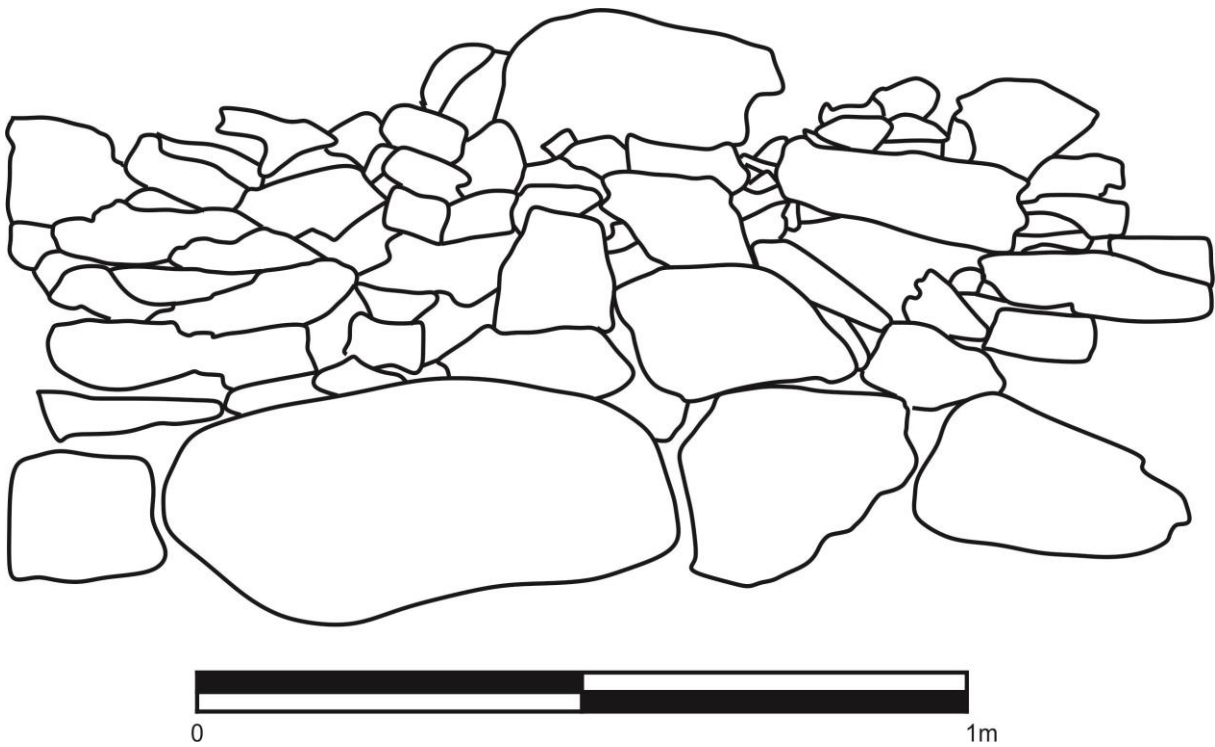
Véase la pared interna del espacio arquitectónico circular, las piedras están dispuestas con las caras planas.
